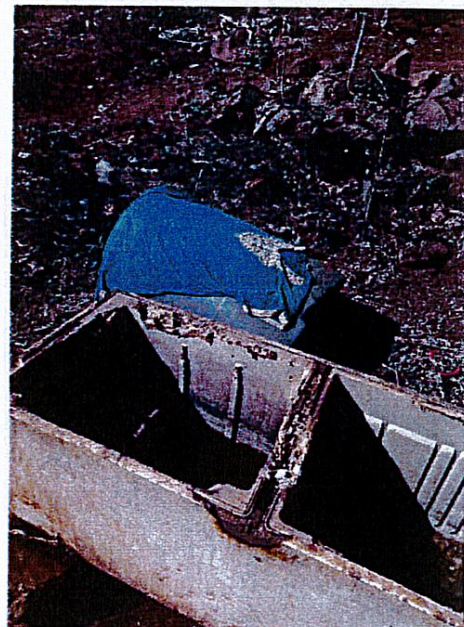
stagnation d'eaux de pluie / gîte larvaire.
